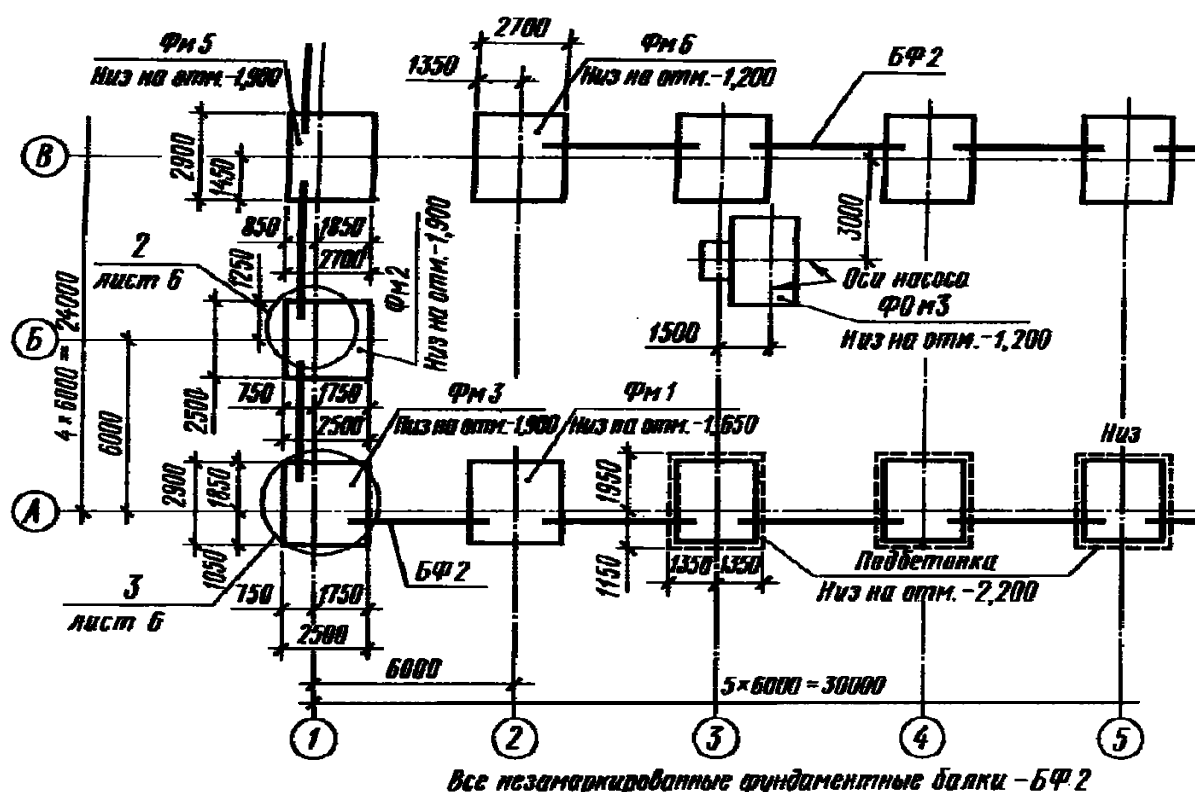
Схема расположения фундаментов и фундаментных балок
